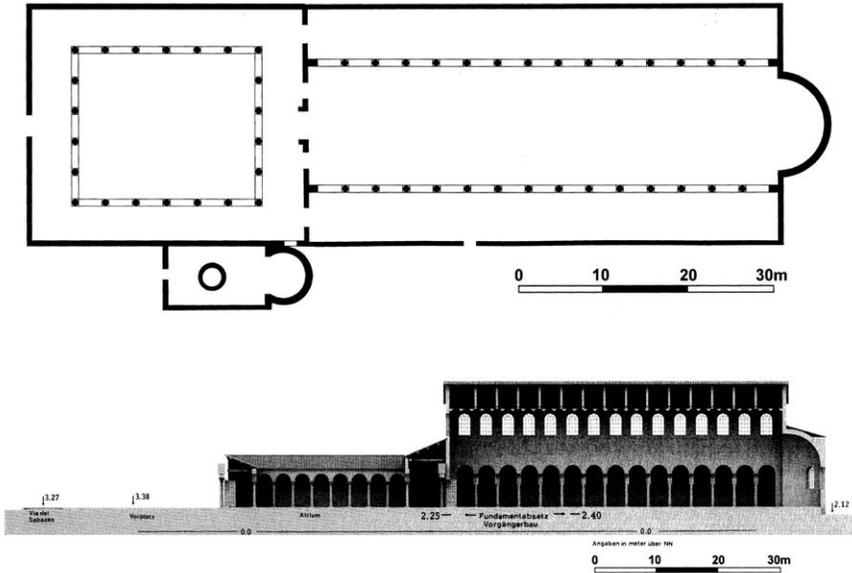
Planimetria e sezione ricostruttiva della chiesa costantiniana dei SS. Pietro, Paolo e Giovanni Battista ad Ostia (da Heinzelmann).
